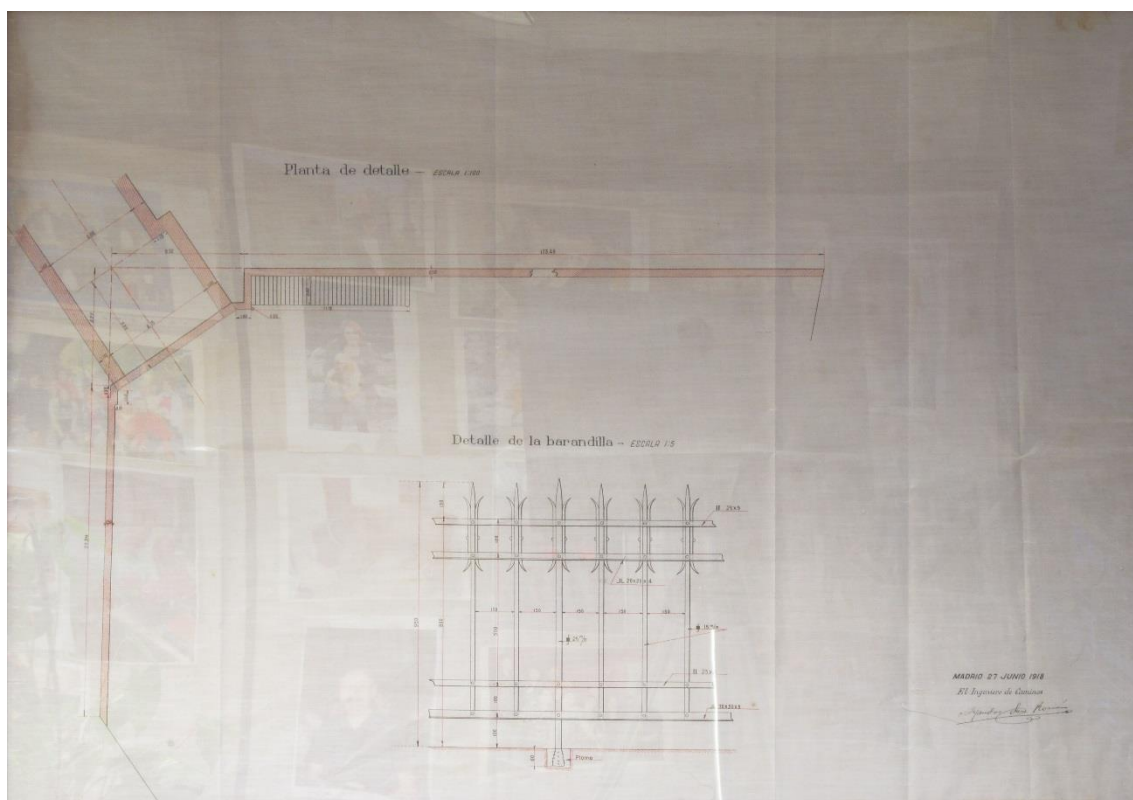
Metropolitano Alfonso XIII: Talleres. Planta de detalle y detalle de la barandilla. 27 de Junio de 1918. Firmado por Alejandro San Román. Archivo Metro
